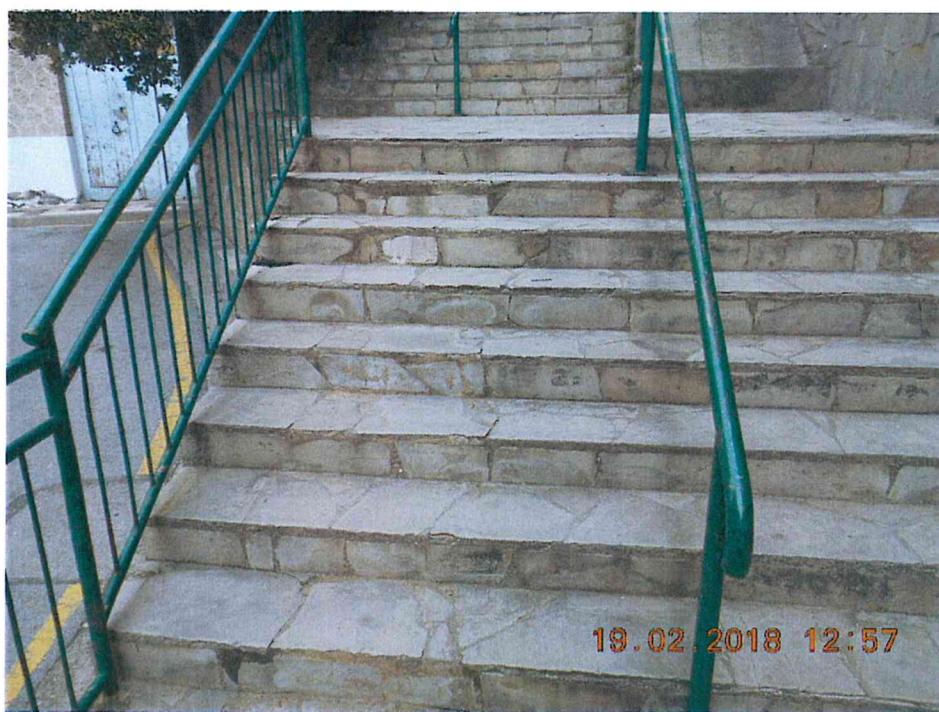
Detall de l'aplicat de pedra de les escales.
